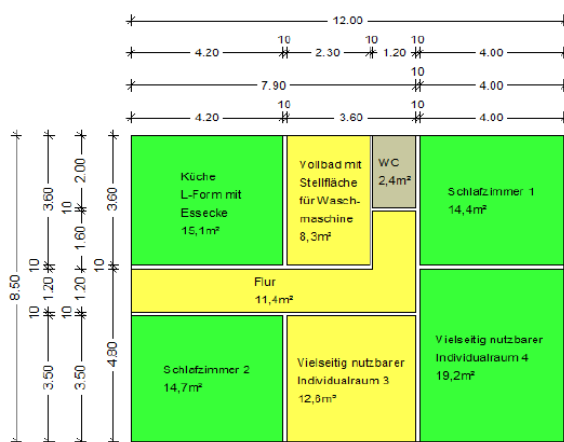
Grundriss 4 (12 m bis 15 m)
